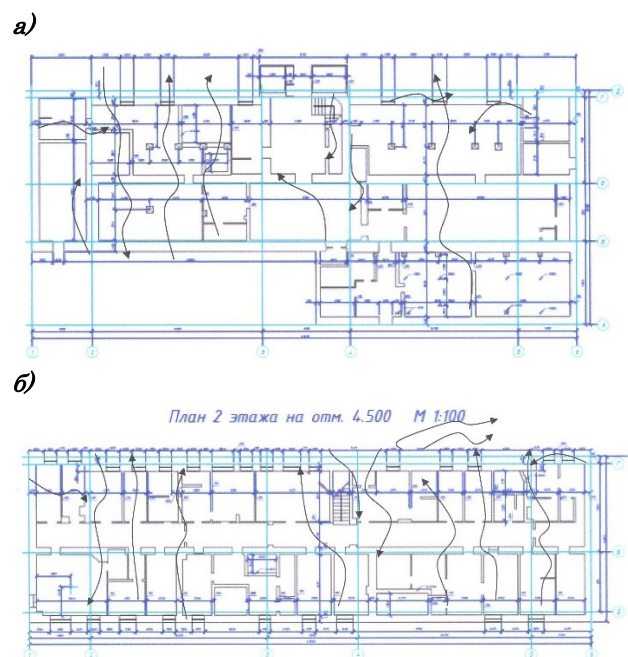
Трещины на стенах и перекрытиях: а – 1-го этажа; стрелка, выходящая за границы стены, указывает на наличие трещин на стеновых конструкциях 1-го этажа; б – 2-го этажа; стрелка, выходящая за границы стены, указывает на наличие сквозных трещин на стеновых конструкциях 2-го этажа
